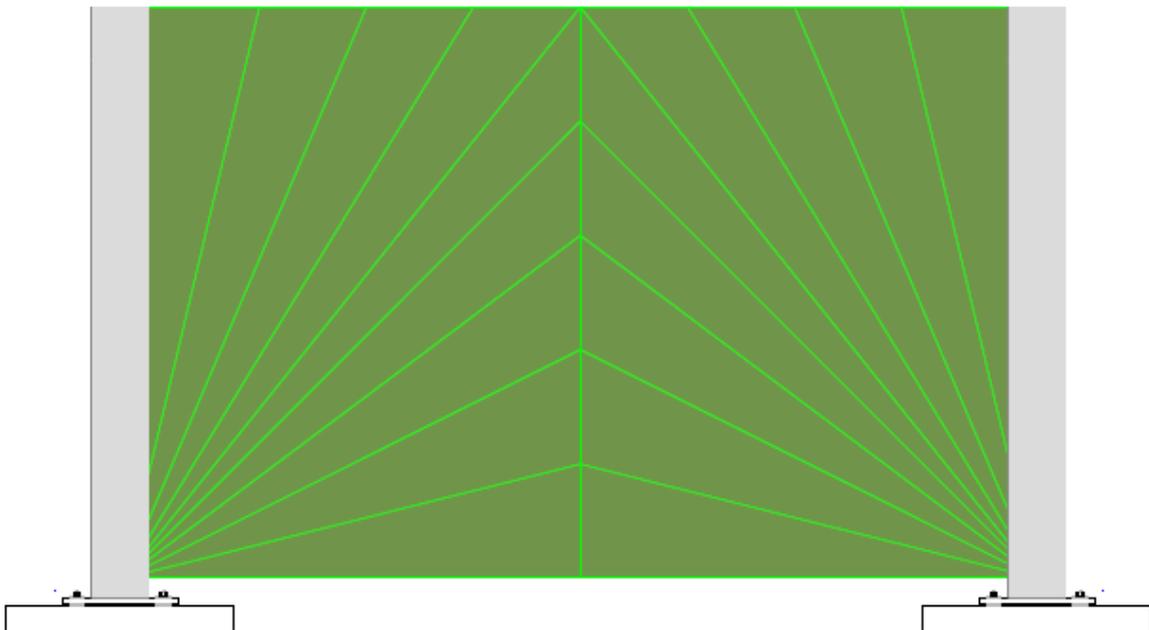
Vista en fachada frontal de la puerta en abanico con apertura hacia arriba de garaje.
